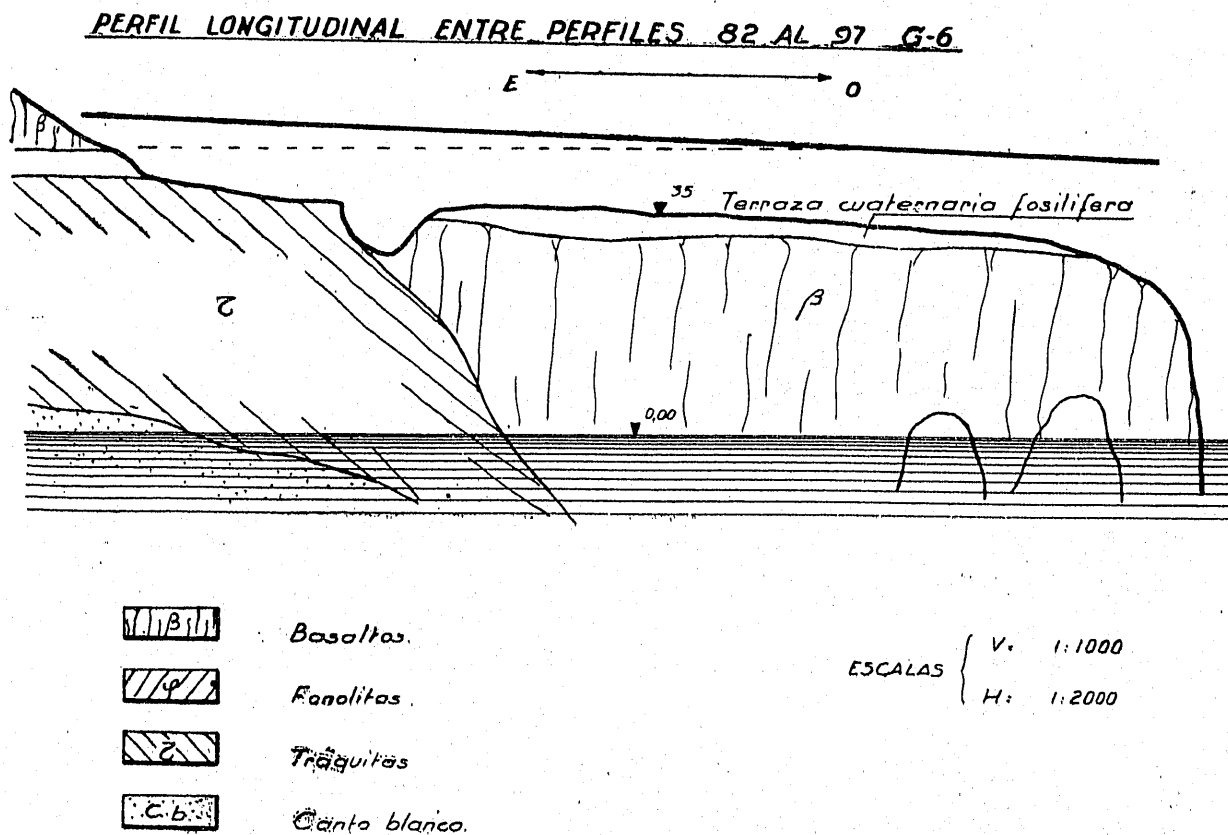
^a — Corte longitudinal G-6, entre perfiles 82 al 97.
